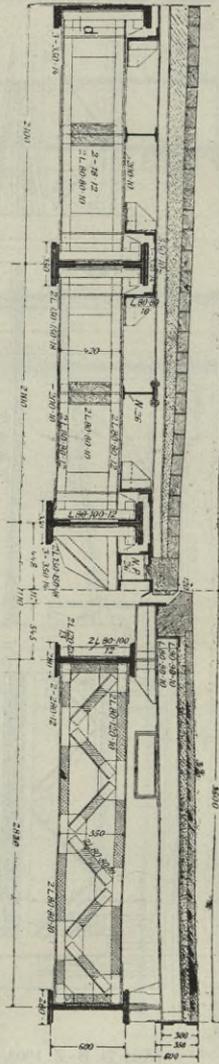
Schwabener-Brücke in Freiburg. Steinplasterdecke auf Belageisen.
